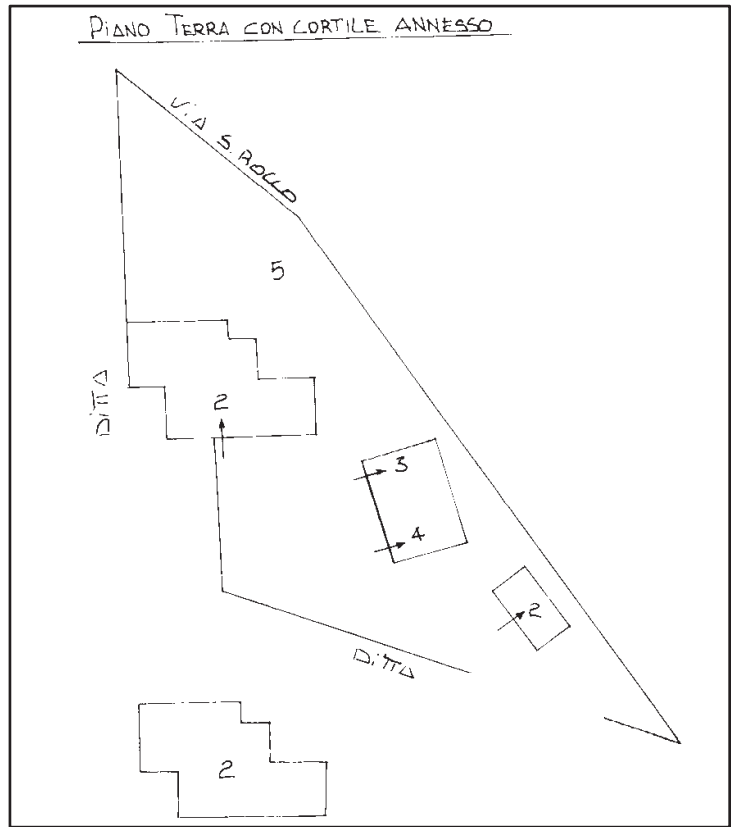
Estratto dell'elaborato planimetrico del 15.02.2001
